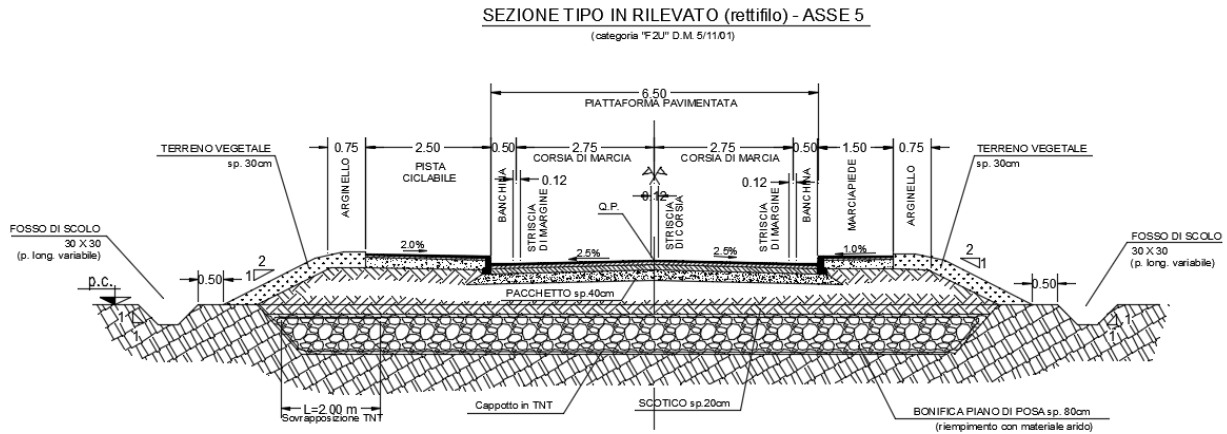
Sezione tipologica in rilevato dell'asse 5
